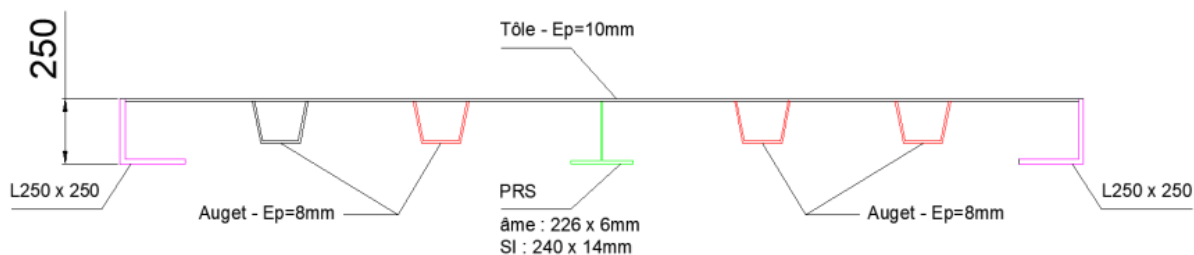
Coupe transversale type d'un platelage métallique (types 5, 6, 7 et 8)
